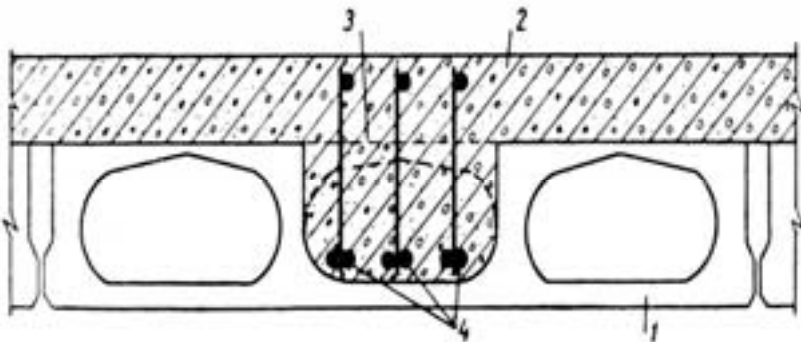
Підсилення пустотілих залізобетонних плит: 1 – існуюча плита;
